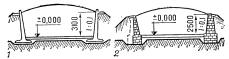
Наземные траншеи: 1 — из железобетонных блоков; 2 — из бутового камня.
